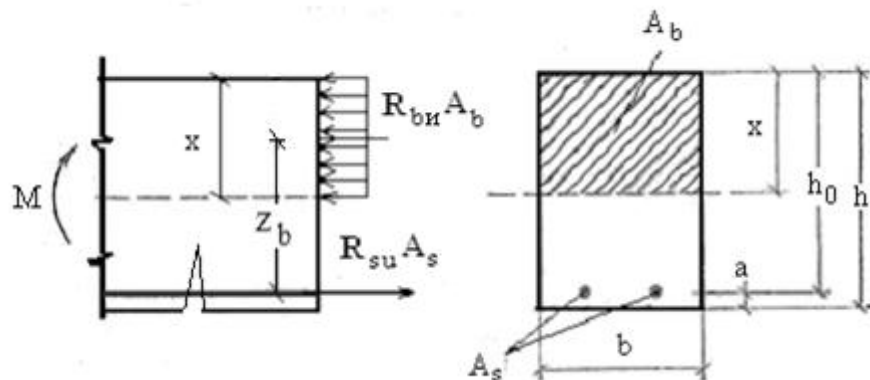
До розрахунку балки за руйнівними зусиллями
